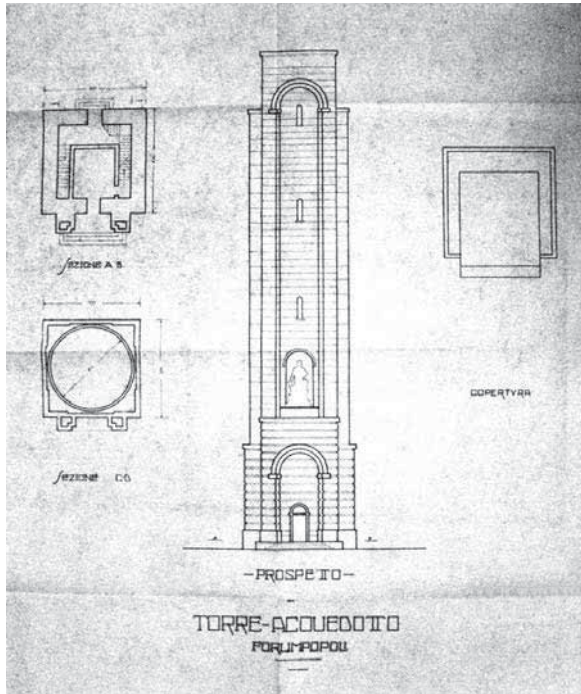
, 18 - G. SERUGHI, *Progetto di torre serbatoio* (mutuato dal novaghiano): prospetto anteriore, sezioni orizzontali, copertura; sezione verticale del fianco e della fondazione, pianta della fondazione, fianco
